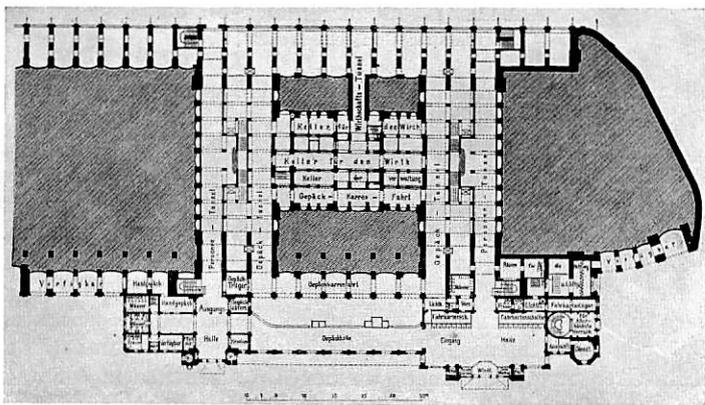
Grundriß des Kölner Hauptbahnhofs (Untergeschoß) von 1894.
